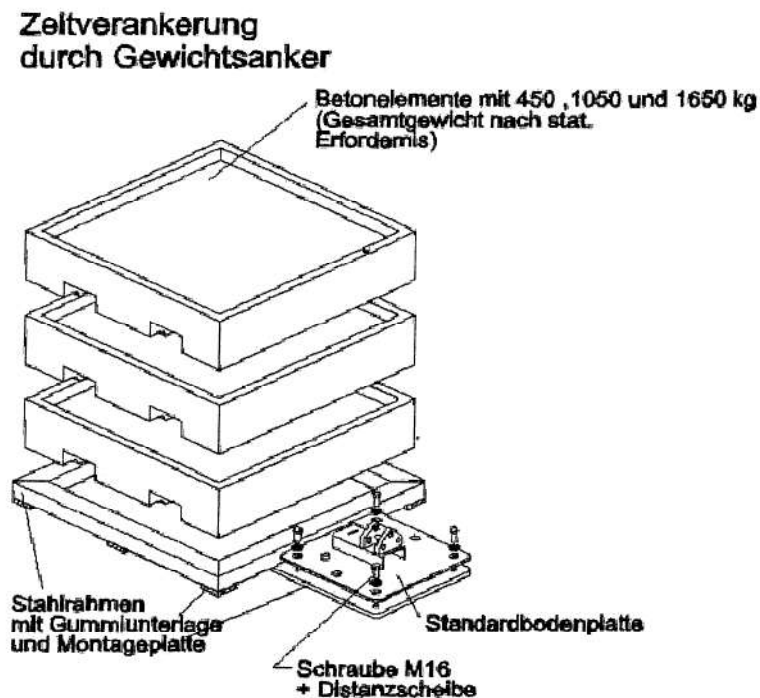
Montage der Bodenplatten mit Hilfe von Gewichtsankern
